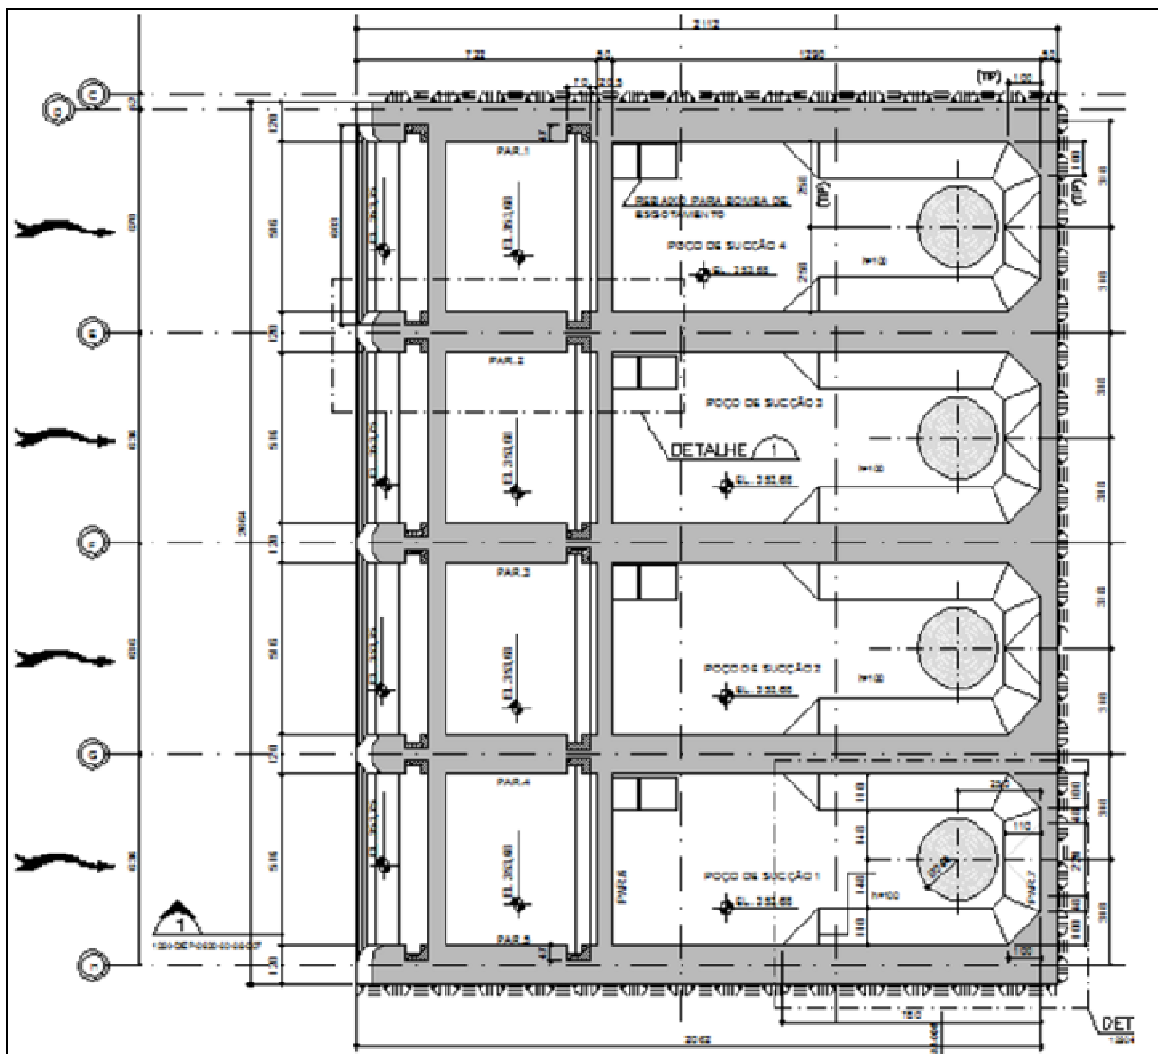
Estação de Bombeamento em Planta – Parte Inferior
